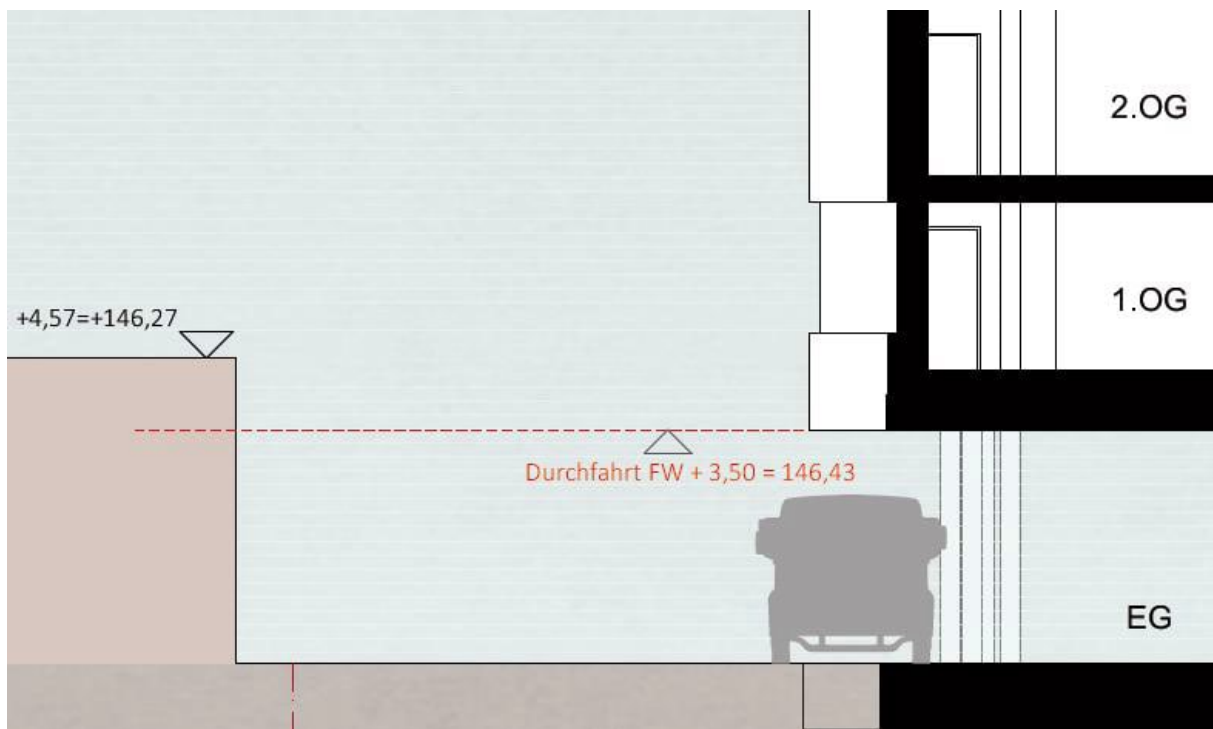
Detailausschnitt – Gebäudeschnitt mit Darstellung der Gebäudeüberkragung
